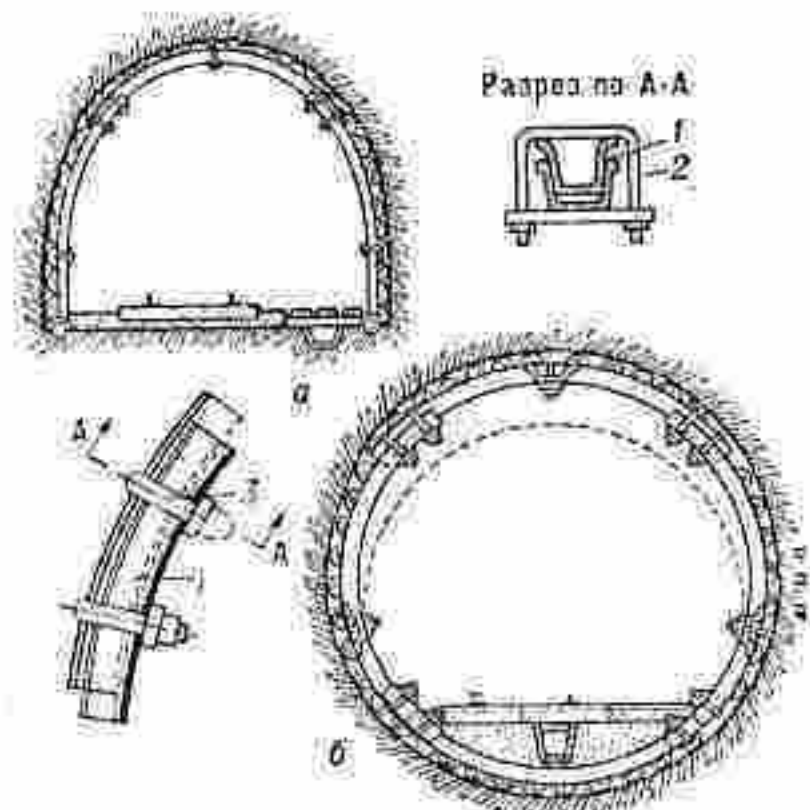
Металлические крепи из спецпрофиля: а — арочная податливая; б — кольцевая податливая; 1 — верхняк; 2 — соединительный хомут; 3 — болт.
